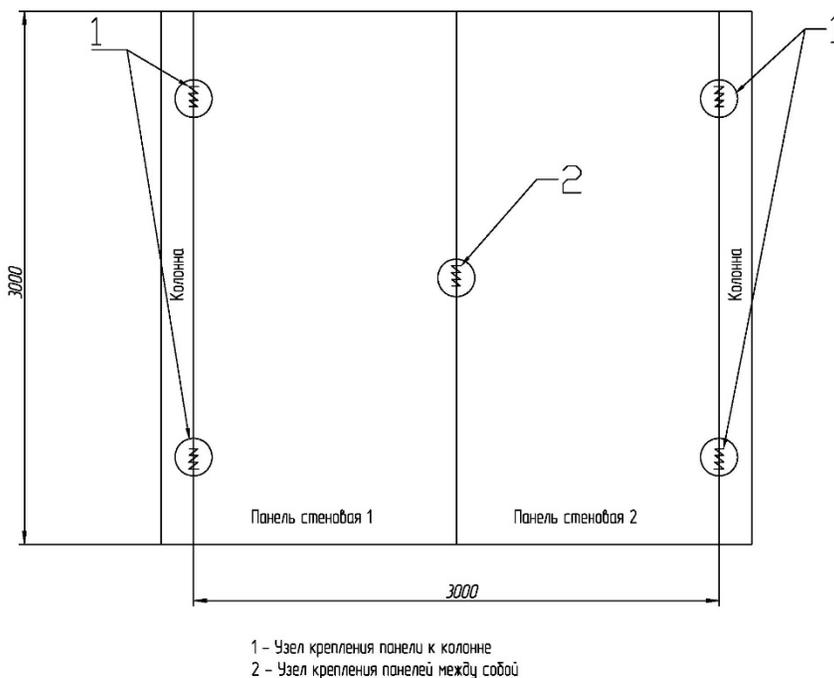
Фрагмент конструкции стены с металлическими узлами крепления и примыкания к колонне
